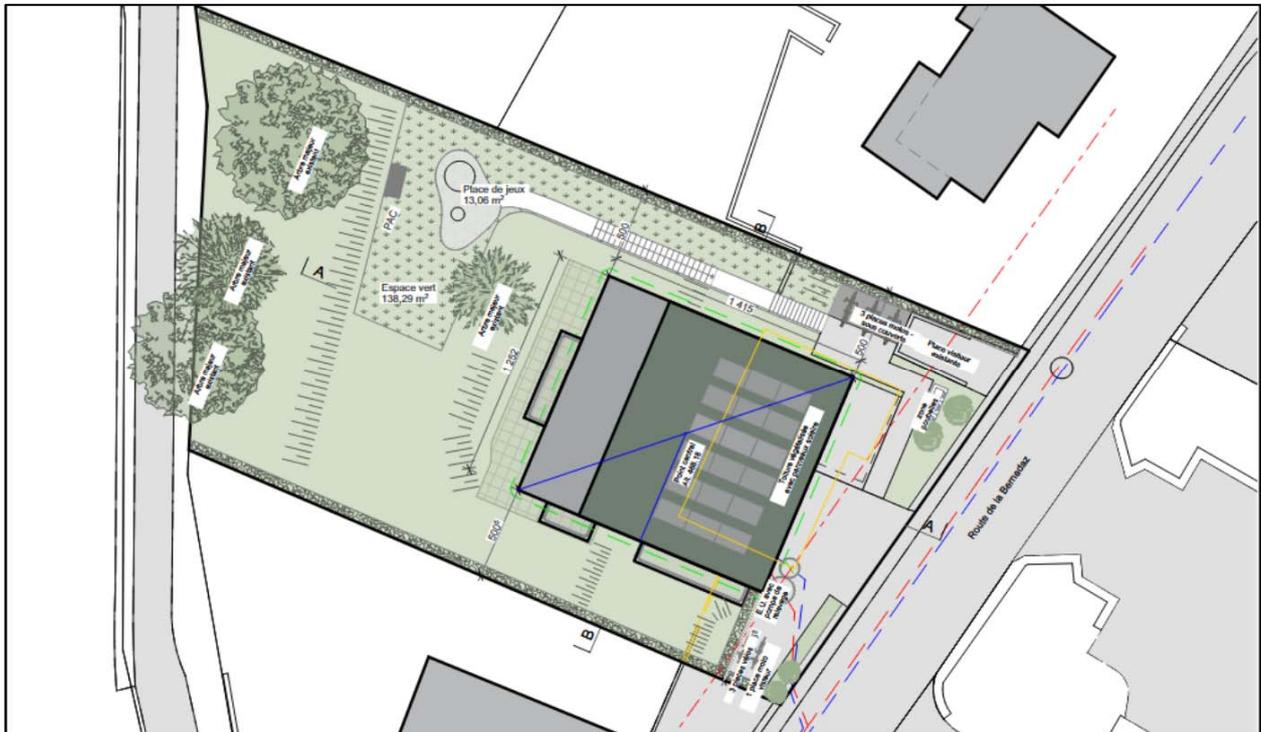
Extrait plan du plan de situation - DMA - 15.01.2025
